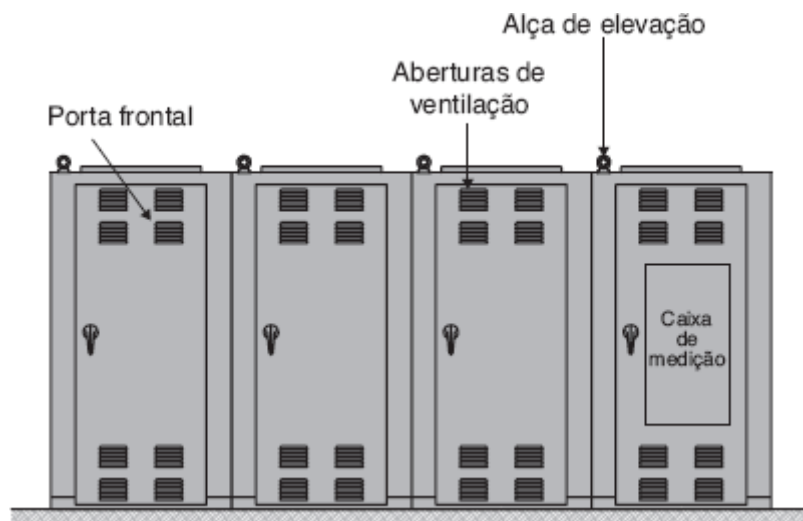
Vista frontal externa de uma subestação modular metálica em chapa de aço.
